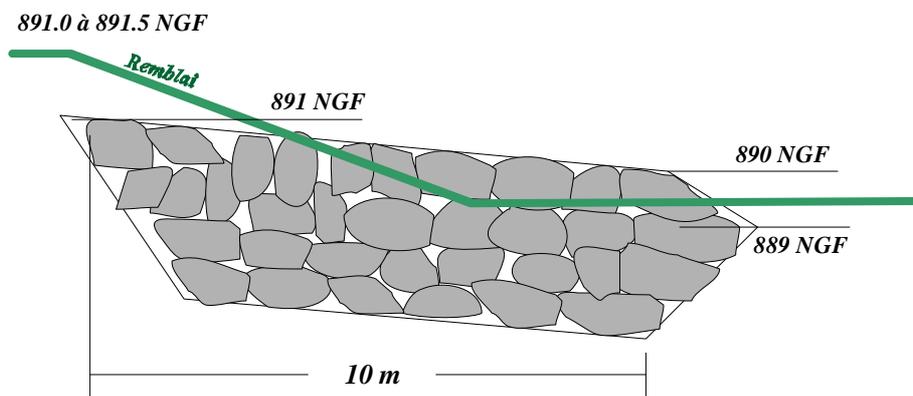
Coupe longitudinale d'un épi de 100 m³ (échelle 1/100)
